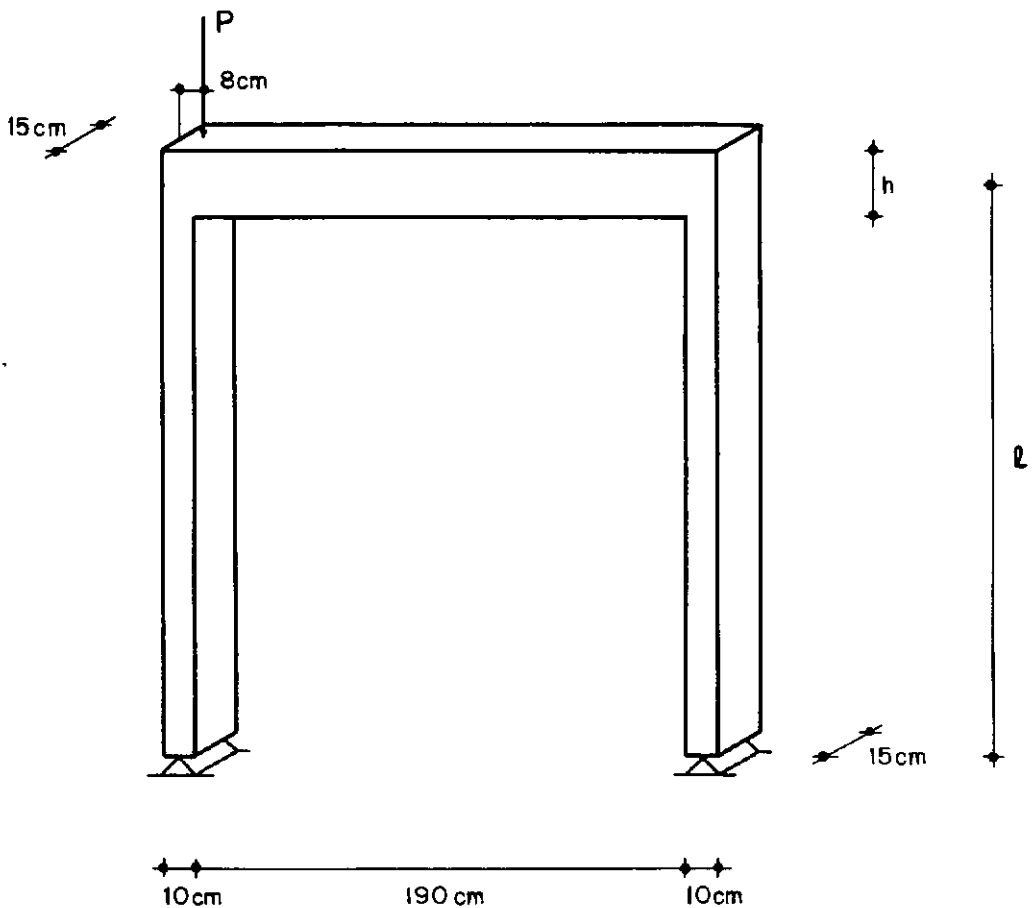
Definição da geometria e do carregamento dos pórticos
